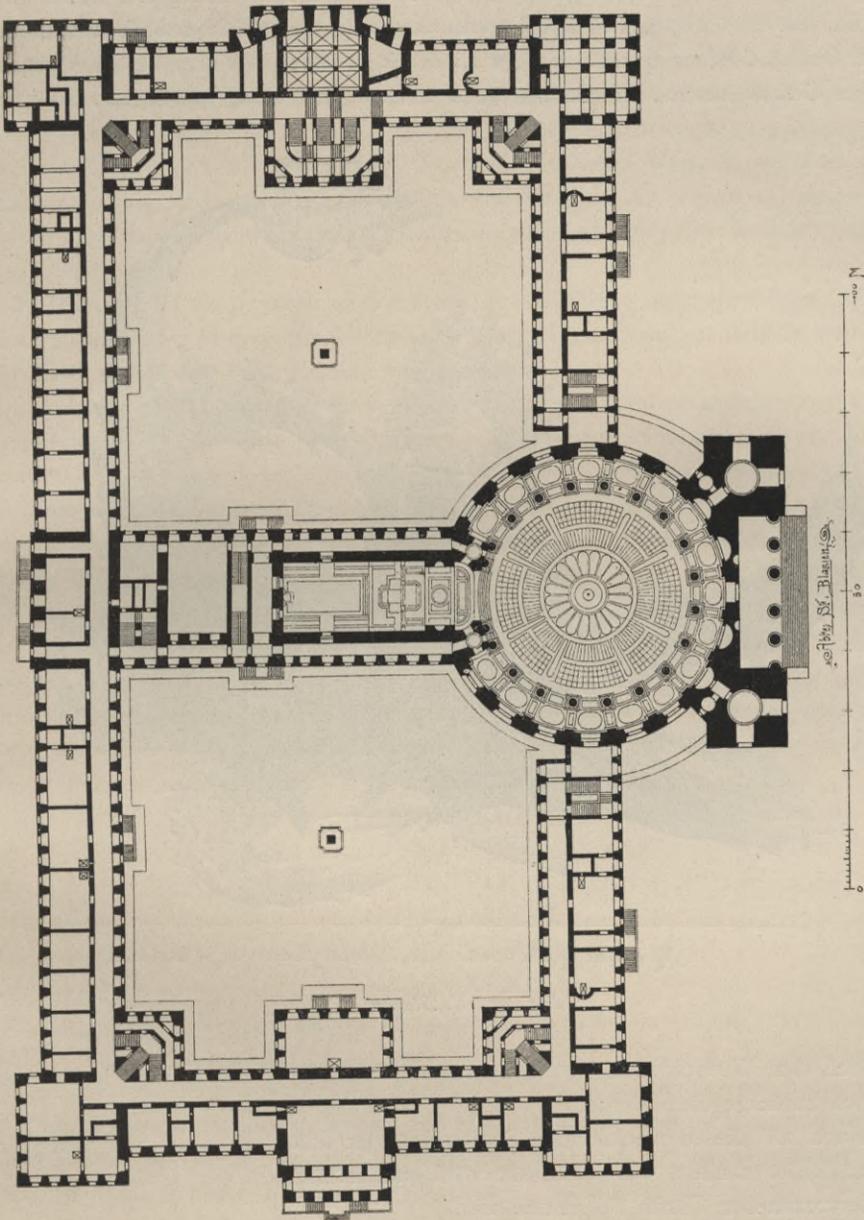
St. Blasien. Grundriss der Abtei S. Blasien (jetziger Bau).
